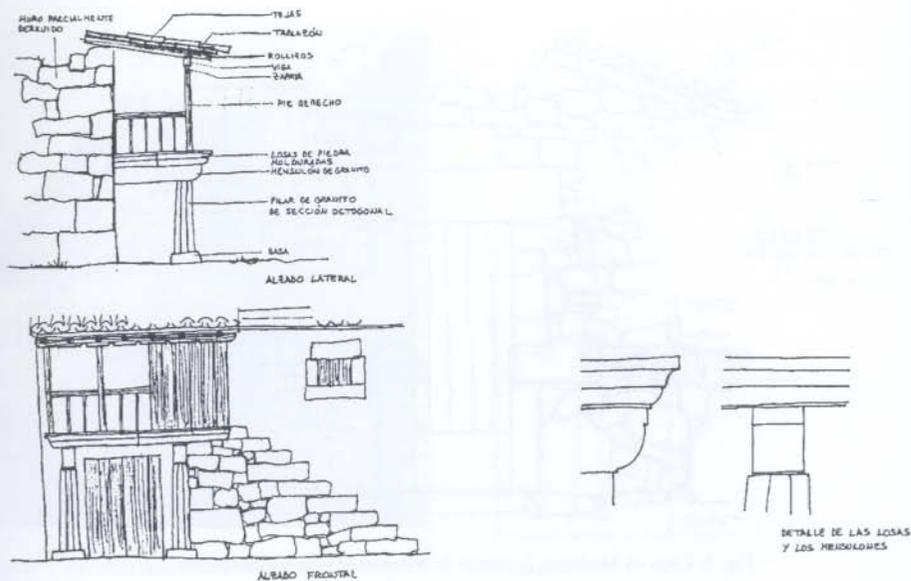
Detalles constructivos de una casa en Vilar con corredor de estructura en piedra y madera combinadas.
